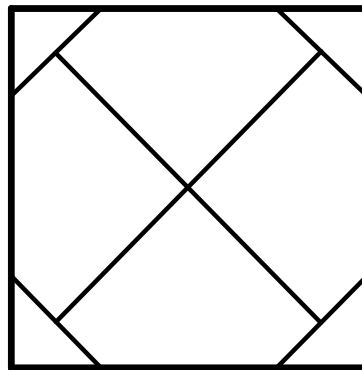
Sistema de contraventamento do tipo “Knee-bracing” [3].
